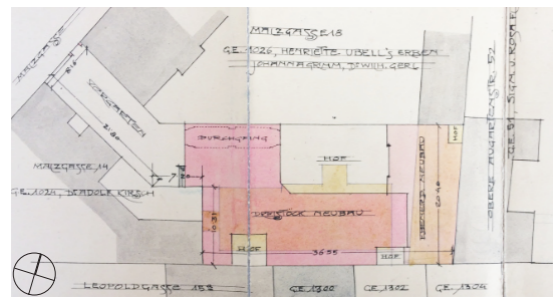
Lageplan Einreichung (9/1906) [ma37]
